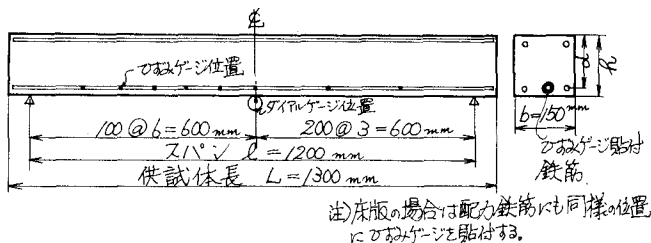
供試体の形状寸法, ダイヤルゲージ位置, およびひび割れゲージ貼付け位置.
